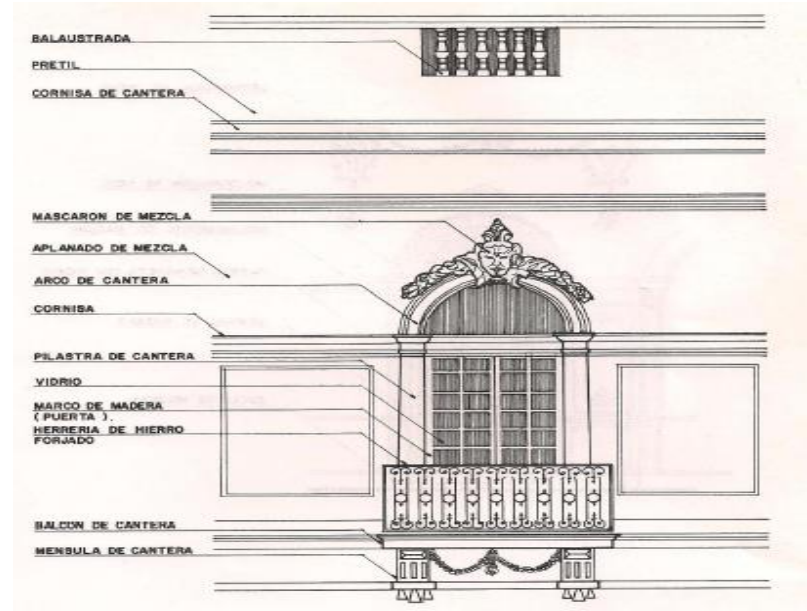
Detalle en fachada donde se utiliza aplanado a base de cal-arena.
